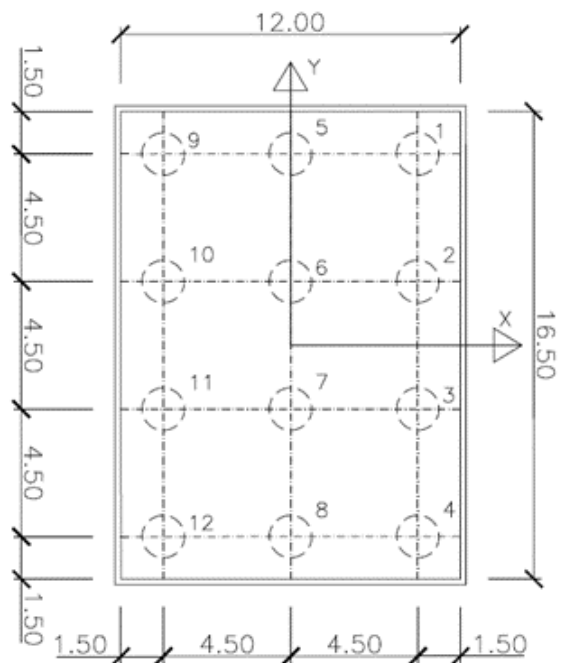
pianta pali – Spalla A- 12 pali
